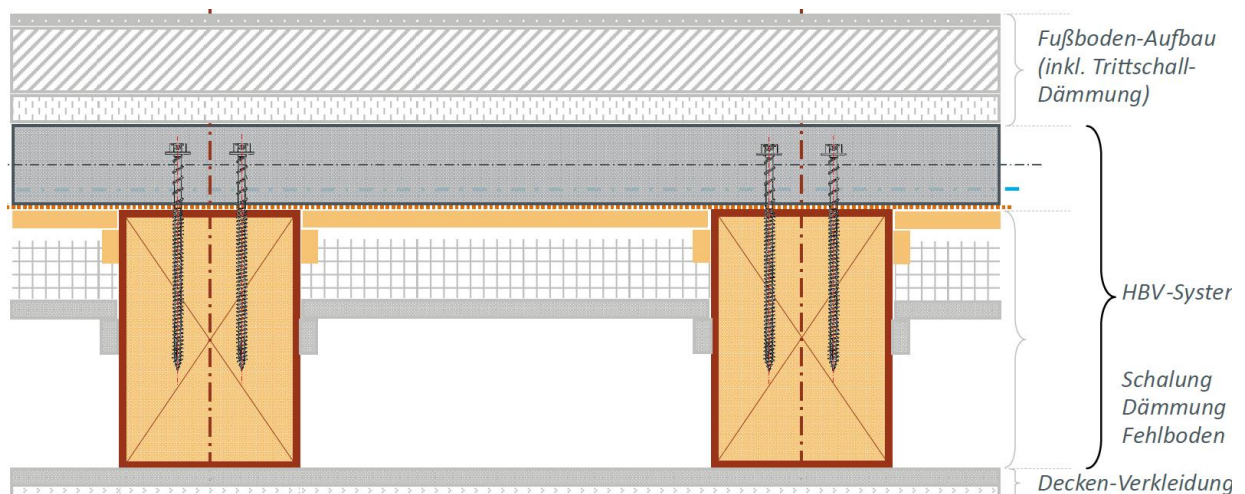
Querschnitt und Deckenaufbau einer typischen Holz-Beton-Verbunddecke [4]
